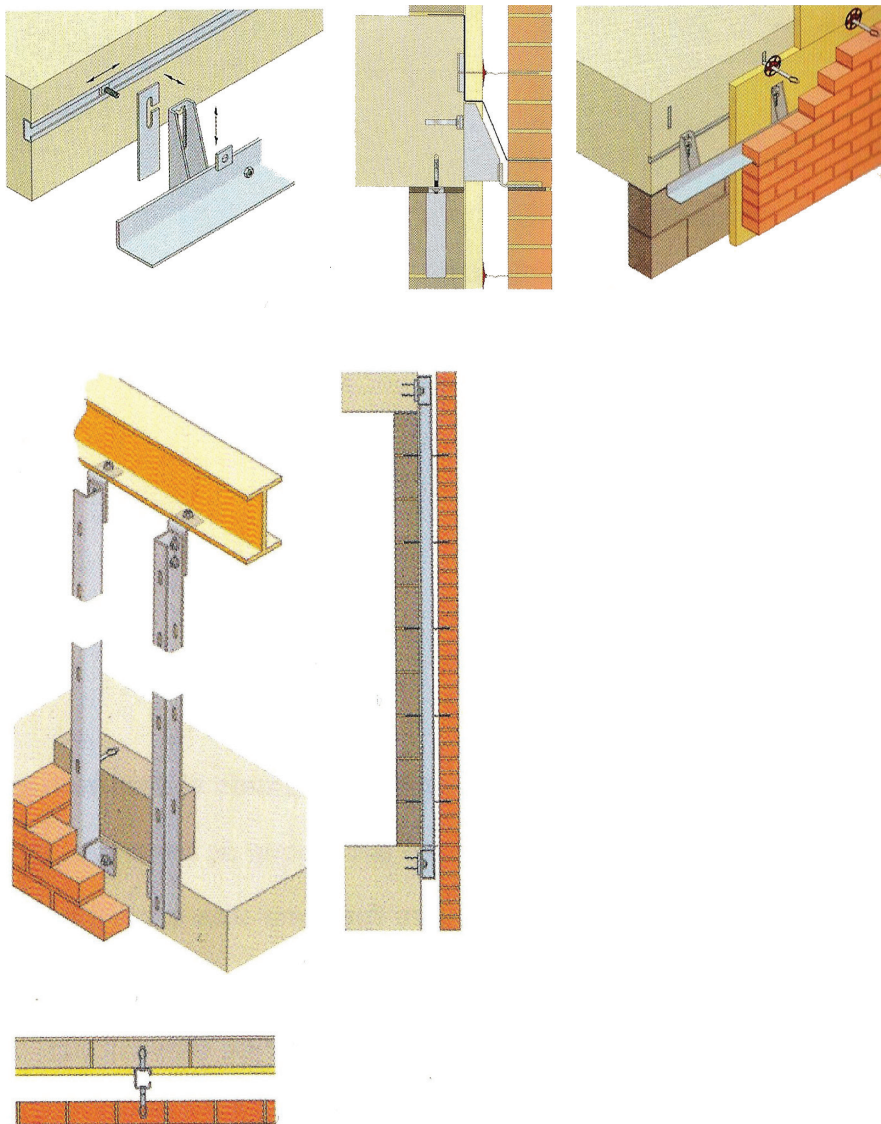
Sistemas metalicos de travamento da alvenaria de tijolo de face à vista em fachadas ventiladas.
